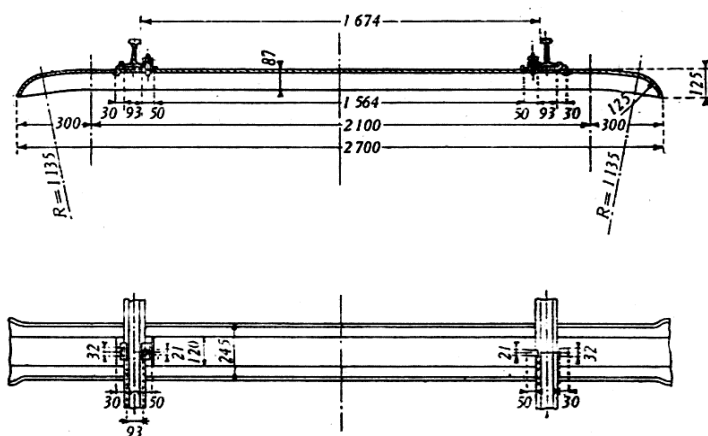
11 Sección longitudinal y planta de un durmiente metálico.¹³
